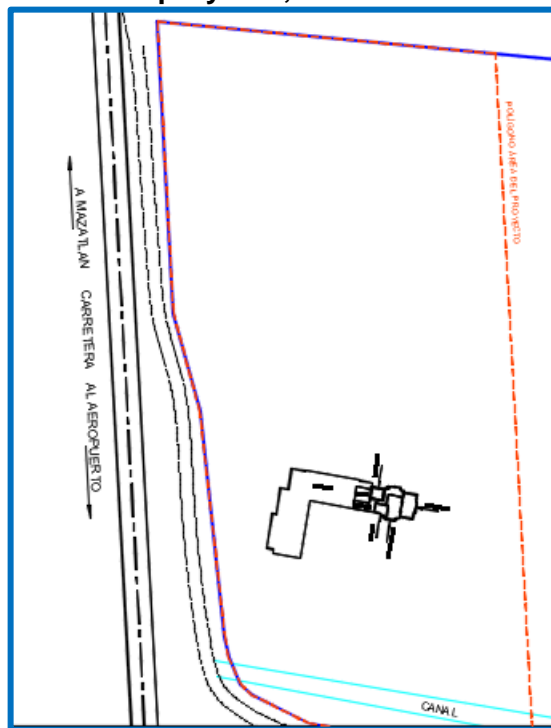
Área de obras y/o actividades del proyecto; Nivel Planta Alta
